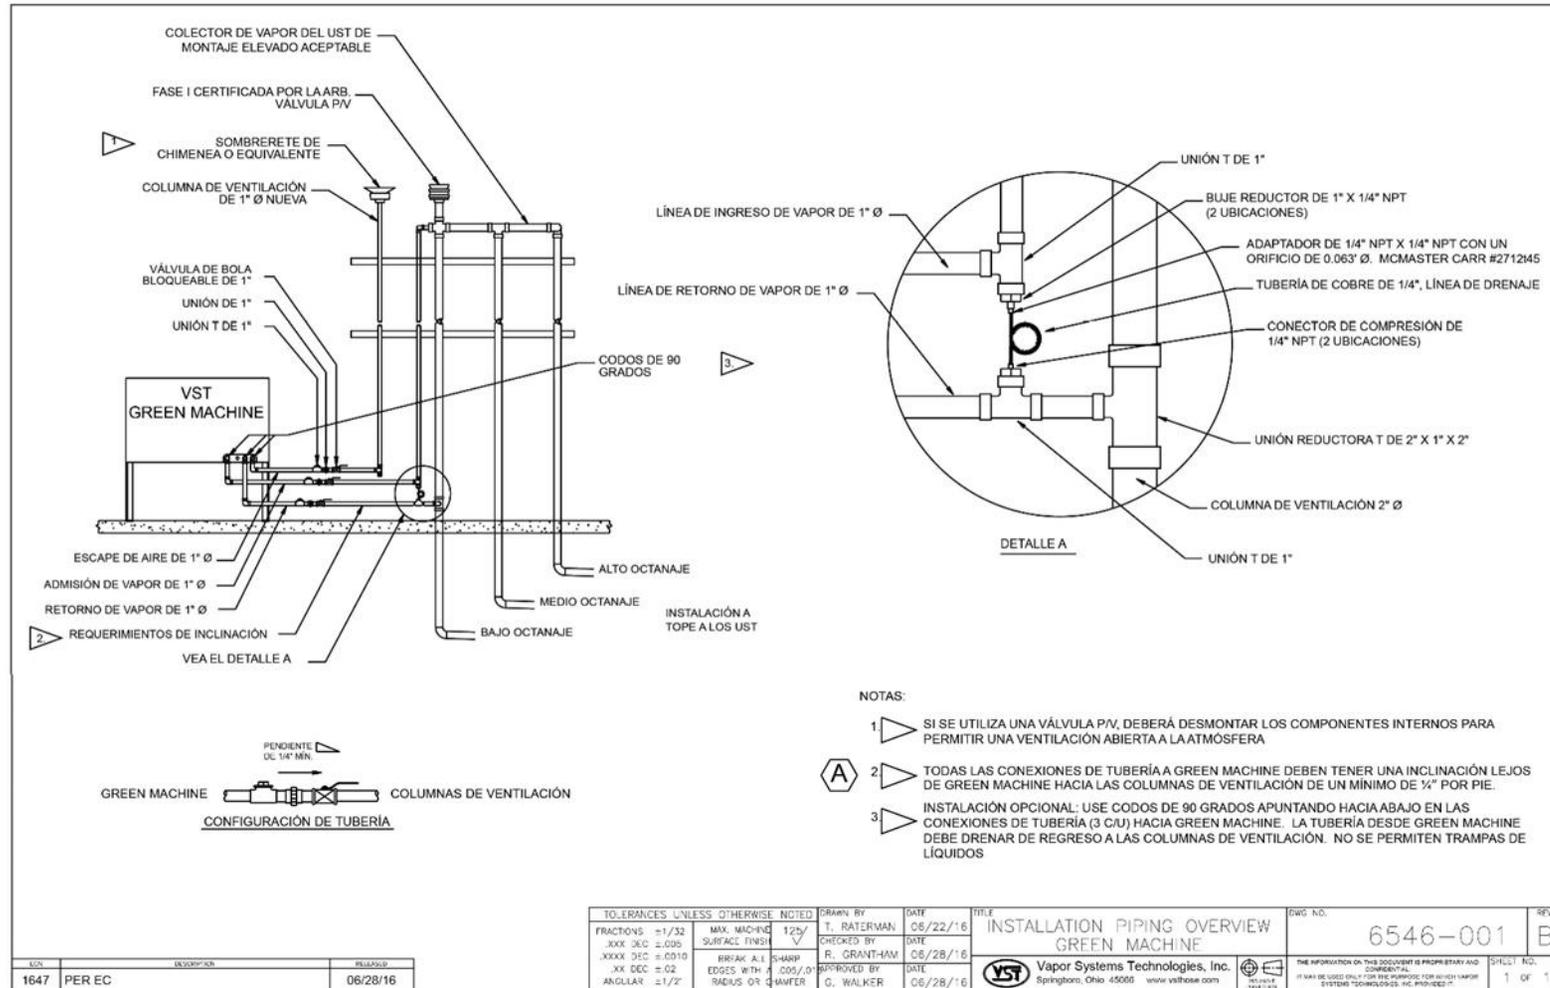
Diseño de la tubería de vapor de la GREEN MACHINE
